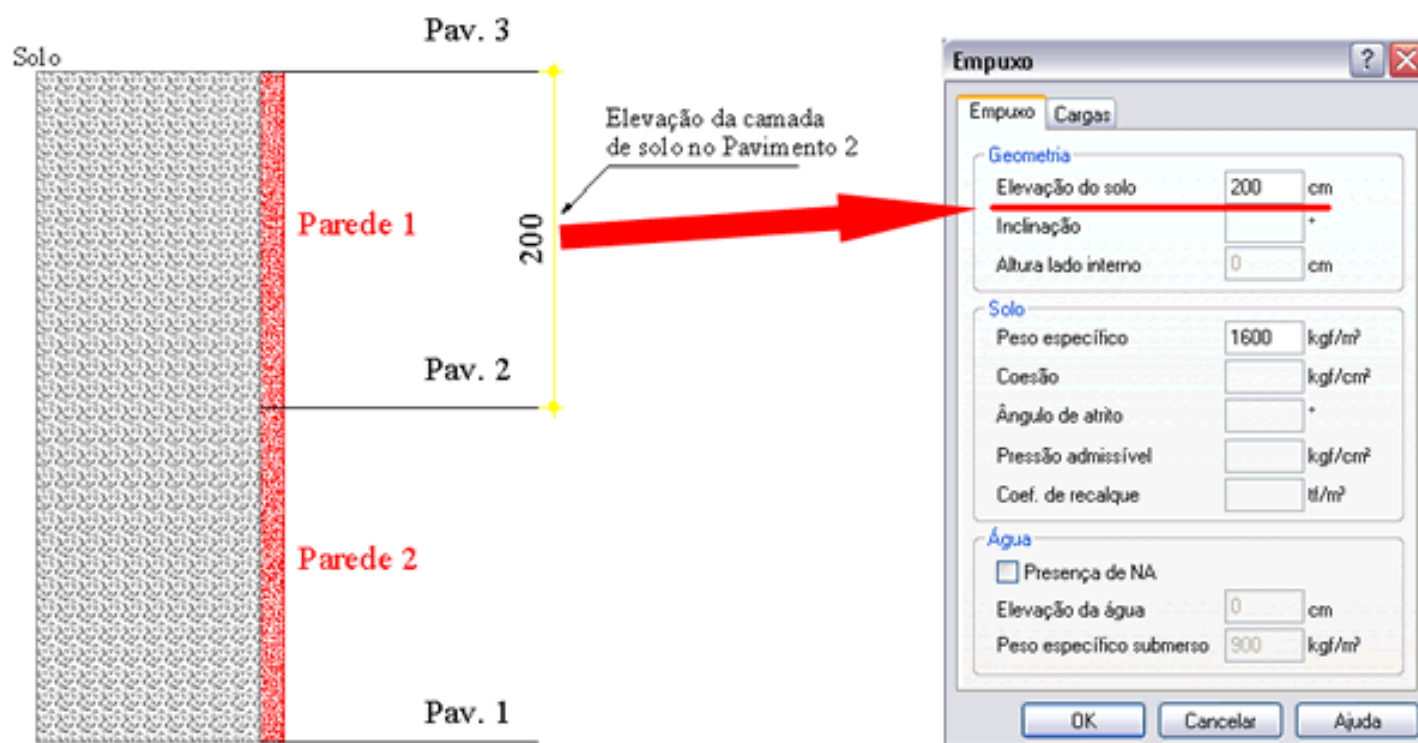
Exemplo: Elevação do solo no Pavimento 2
